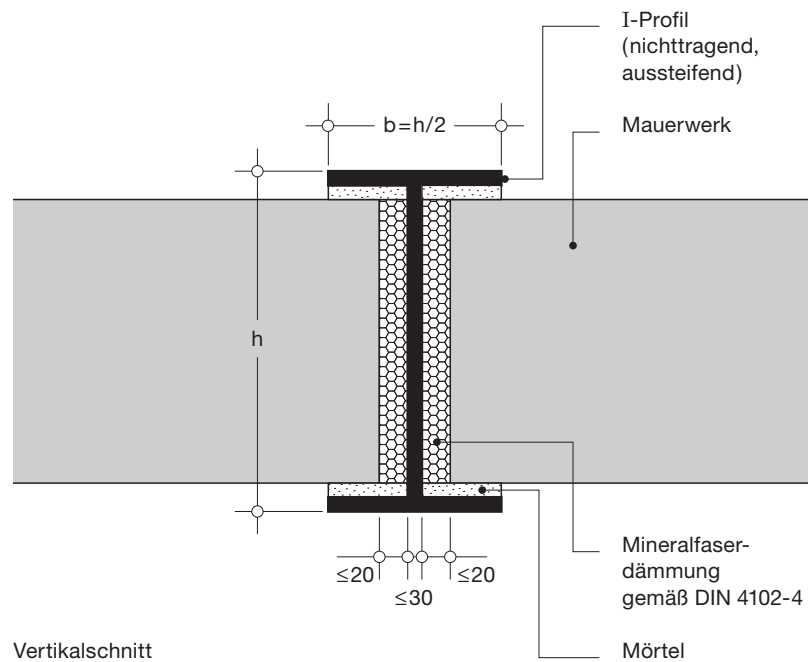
Porenbeton-Mauerwerkswand mit unbekleidetem Stahlprofil, F 30-A
